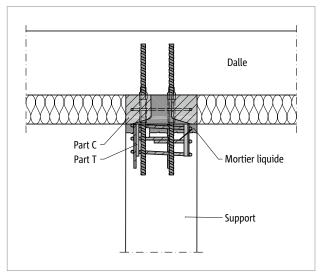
Schöck Sconnex® type P : coupe de montage ; raccordement poteau carré - dalle avec Part C et Part T
